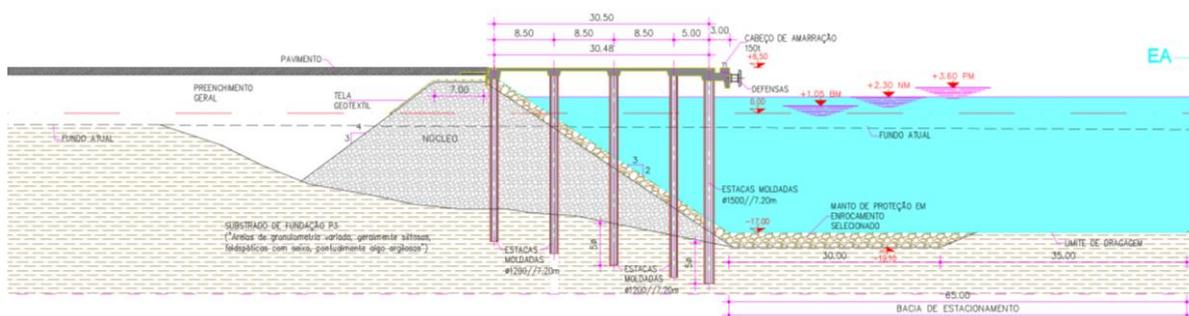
Solução 3: Cais em tabuleiro betonado "in situ" apoiado em estacas moldadas de betão armado
